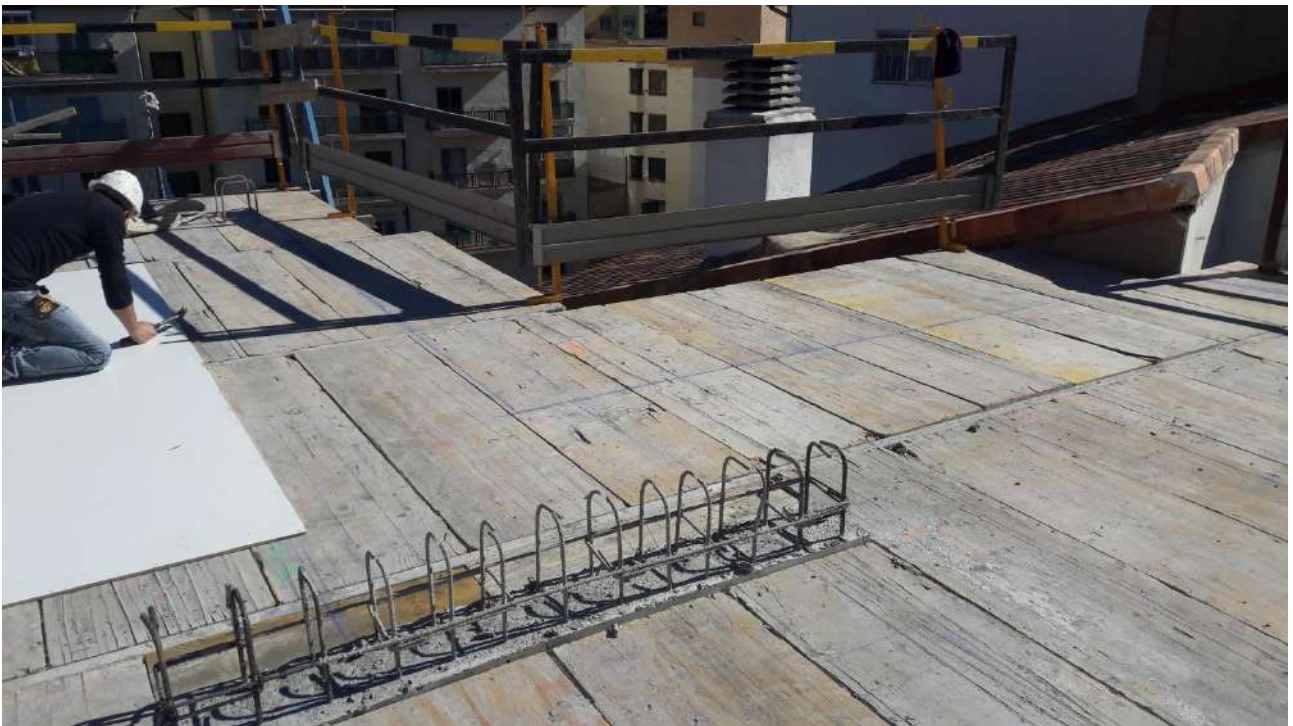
Colocación de tablero fenólico en zonas de forjado de hormigón visto.
